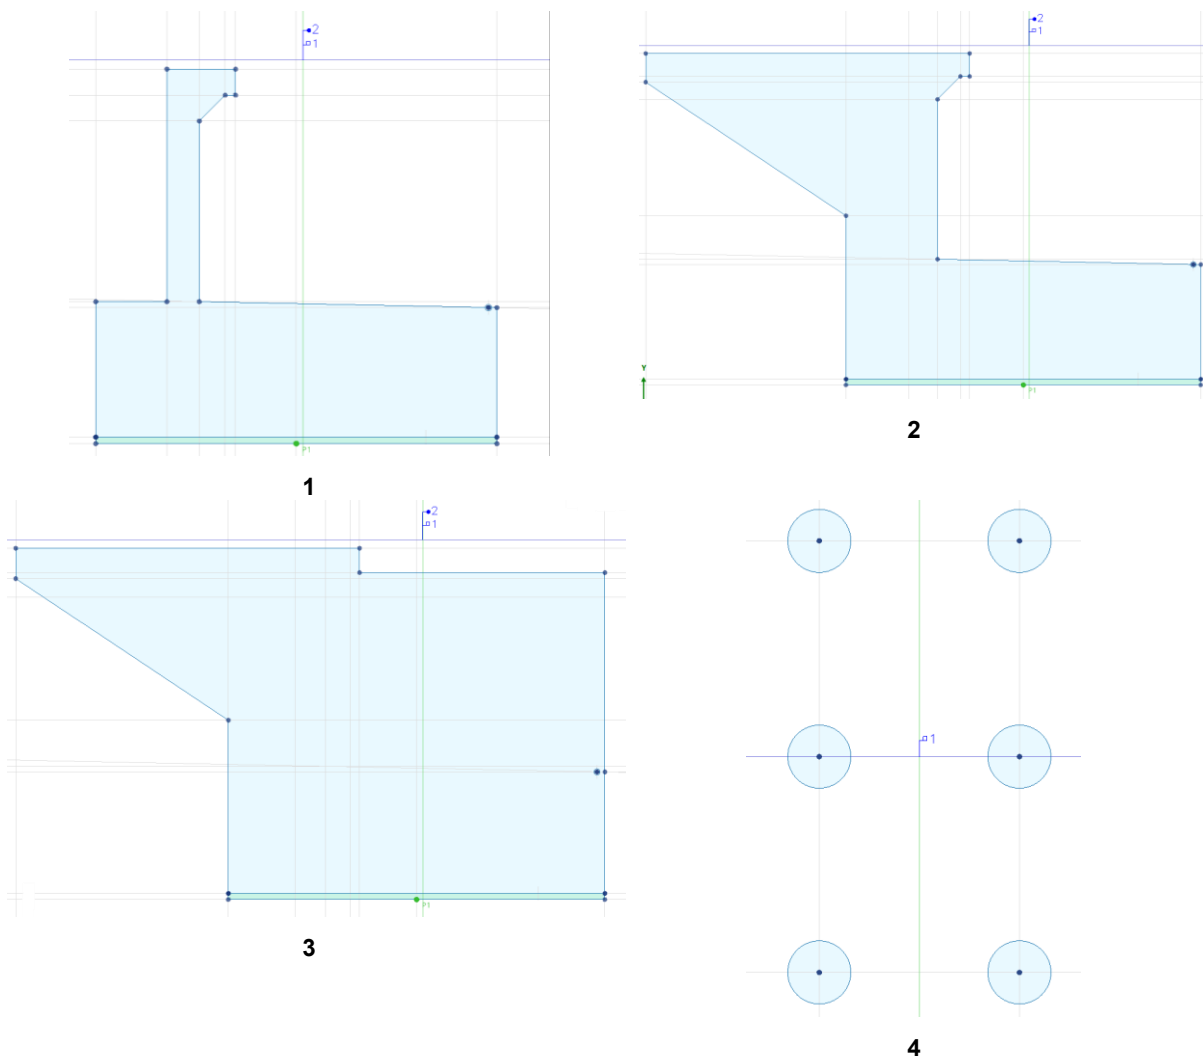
Secções transversais dos encontros no *Allplan Bridge
